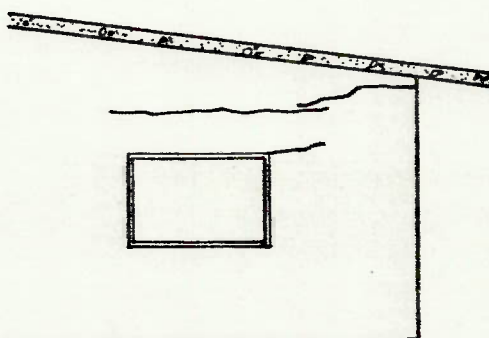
Fissuras em parede externa, promovidas pela retração da laje de cobertura
